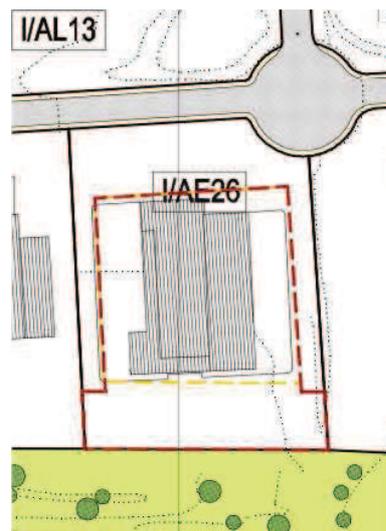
Extracto da Planta de Implantação do PPIPIP, alteração, Parcela I/AE26 - Lote 31
